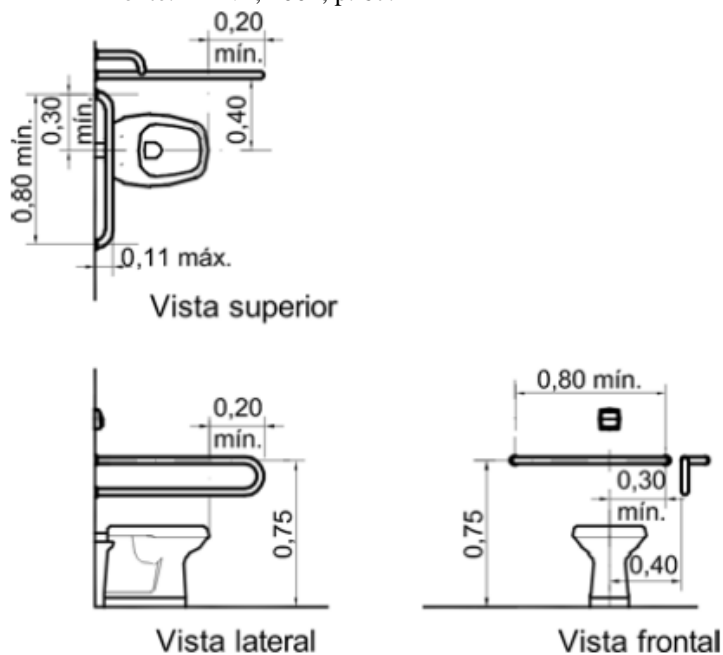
Bacia sanitária com barras de apoio lateral com fixação na parede de fundo
